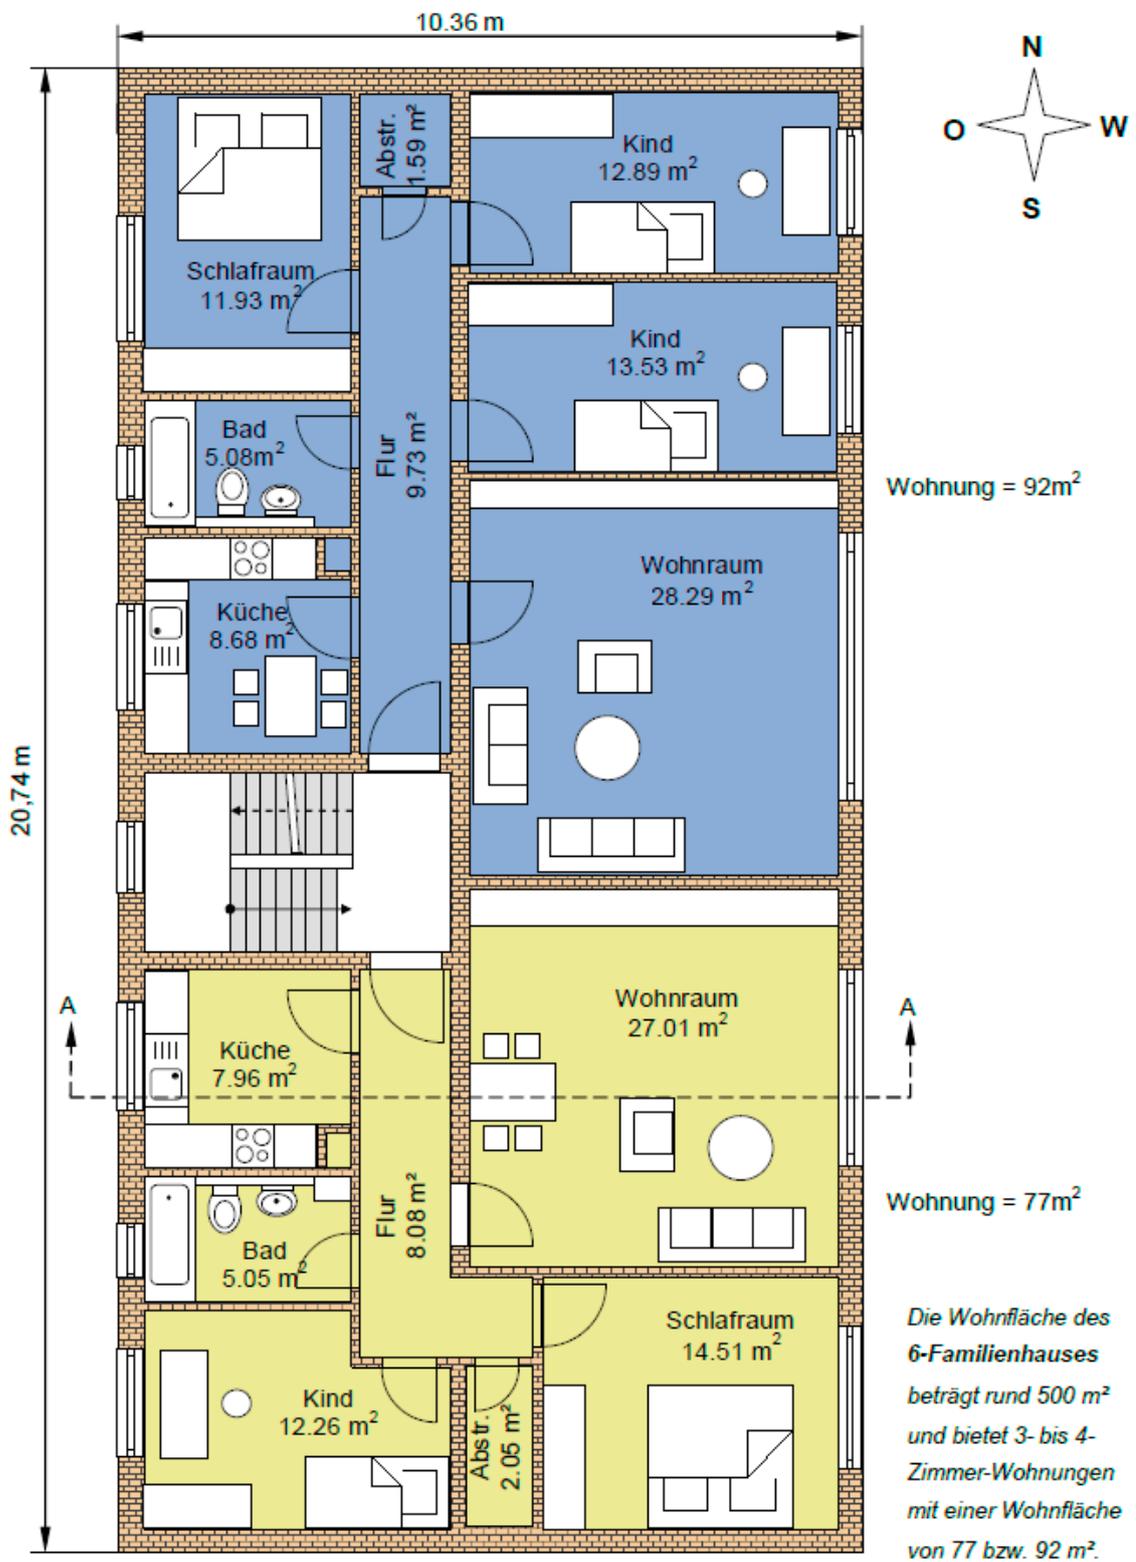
Grundriss: 6-Familienhaus [BGW]
